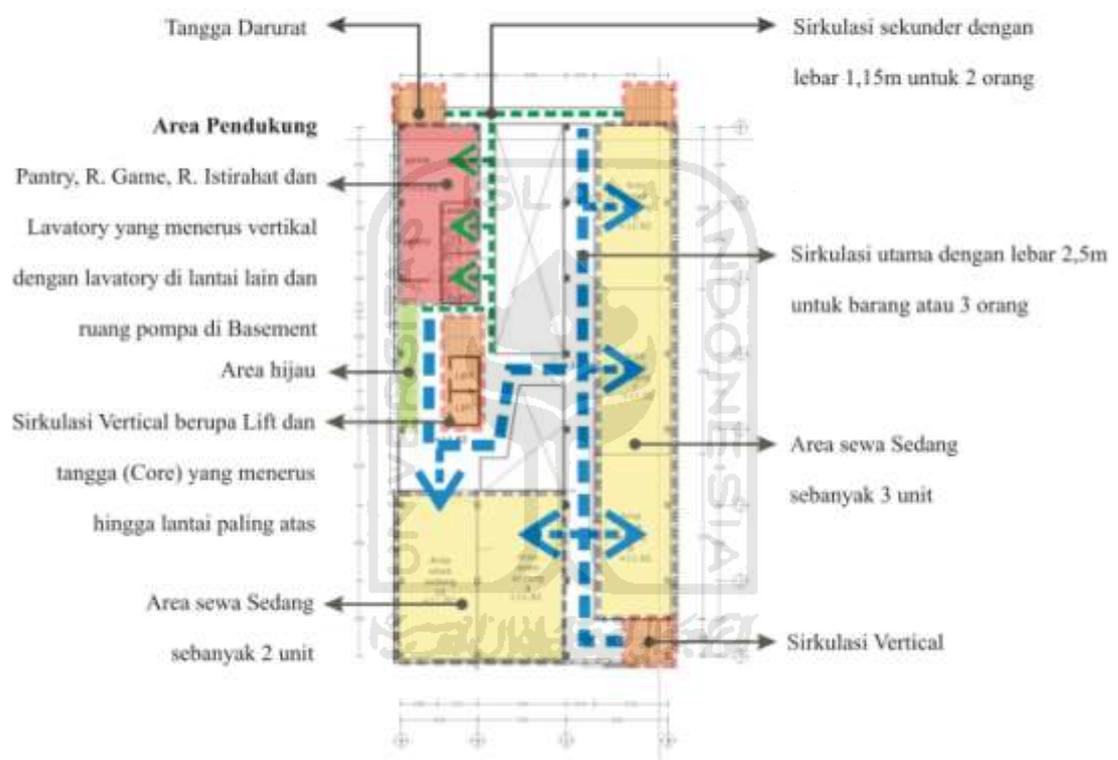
Konsep Zonase Ruang Lantai 2
